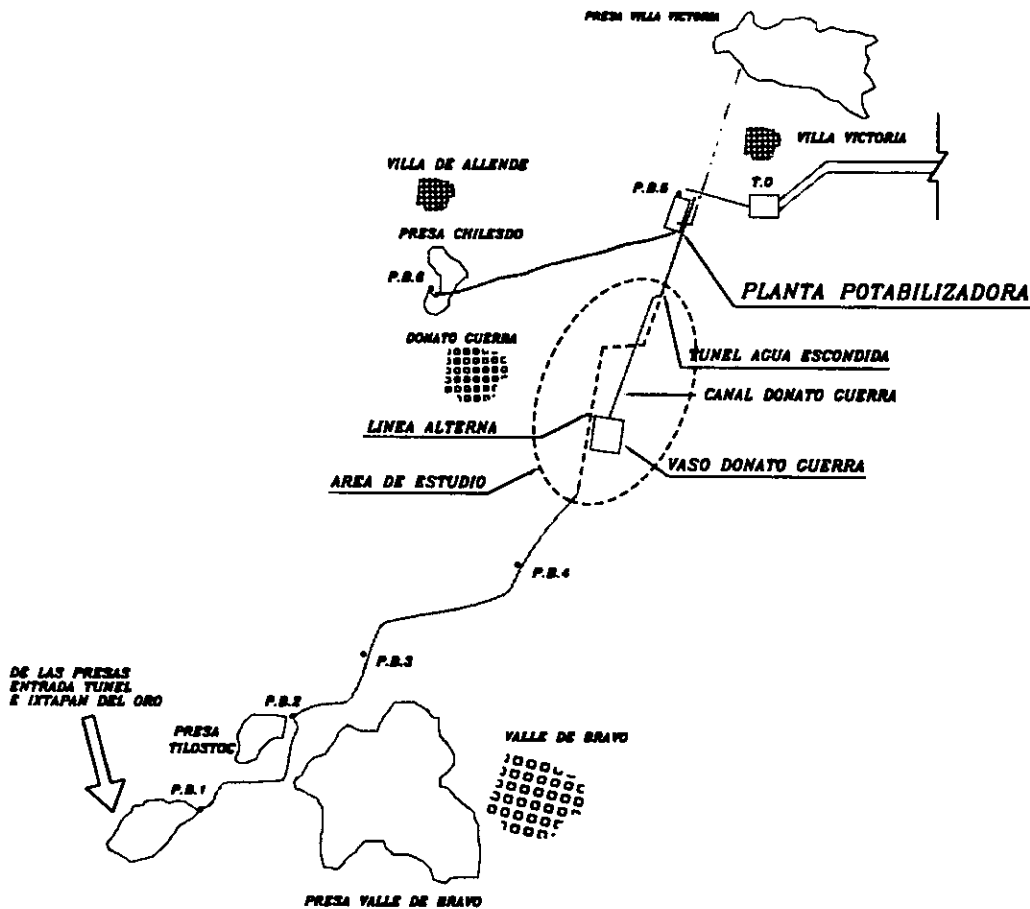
Planta del tramo PBI- Planta potabilizadora "los Berros". Sistema Cutzamala
